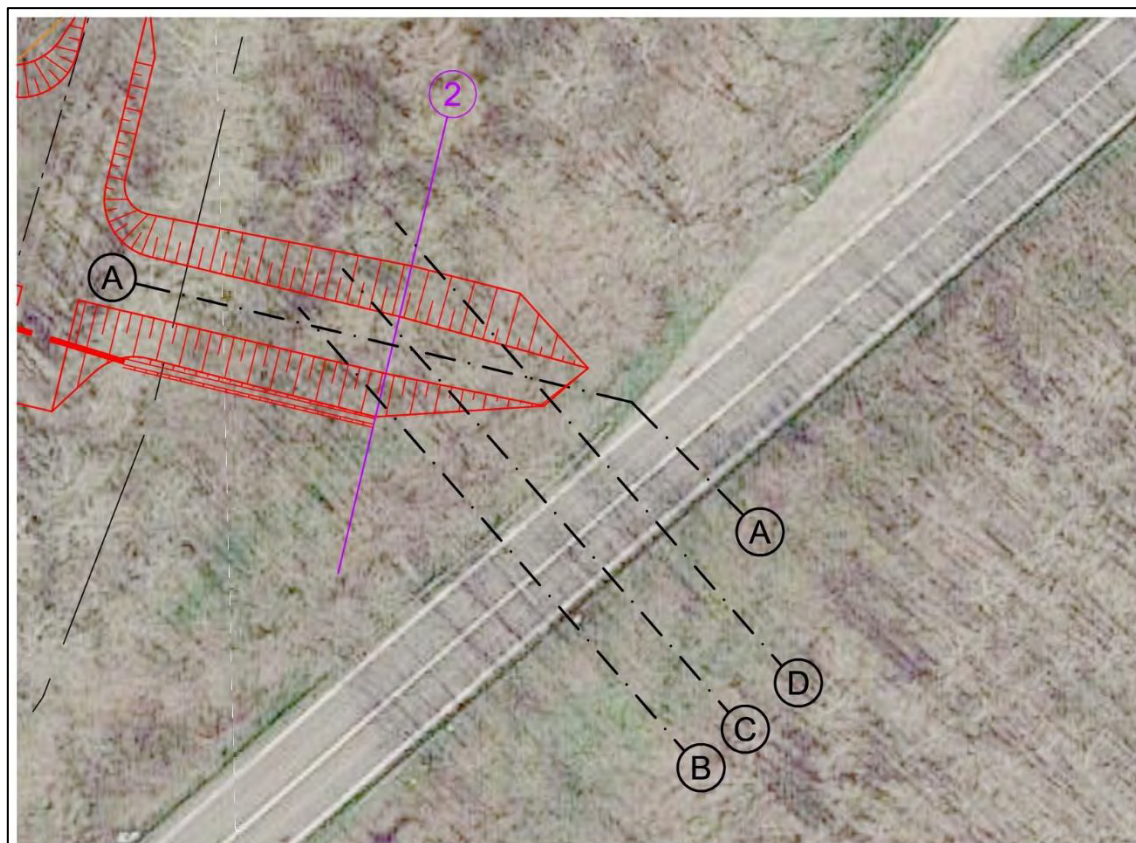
Planimetria con indicazione delle sezioni A÷D
